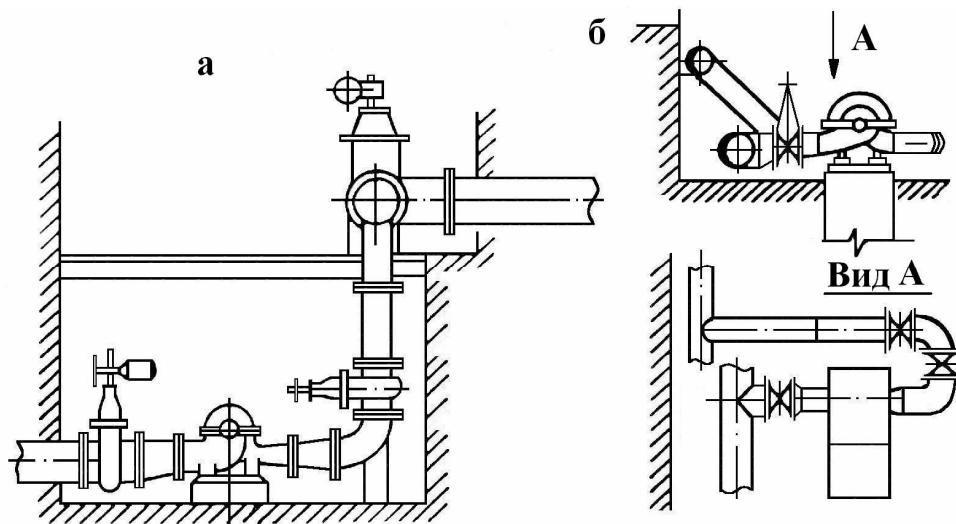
Схемы размещения внутриванционных трубопроводов:
